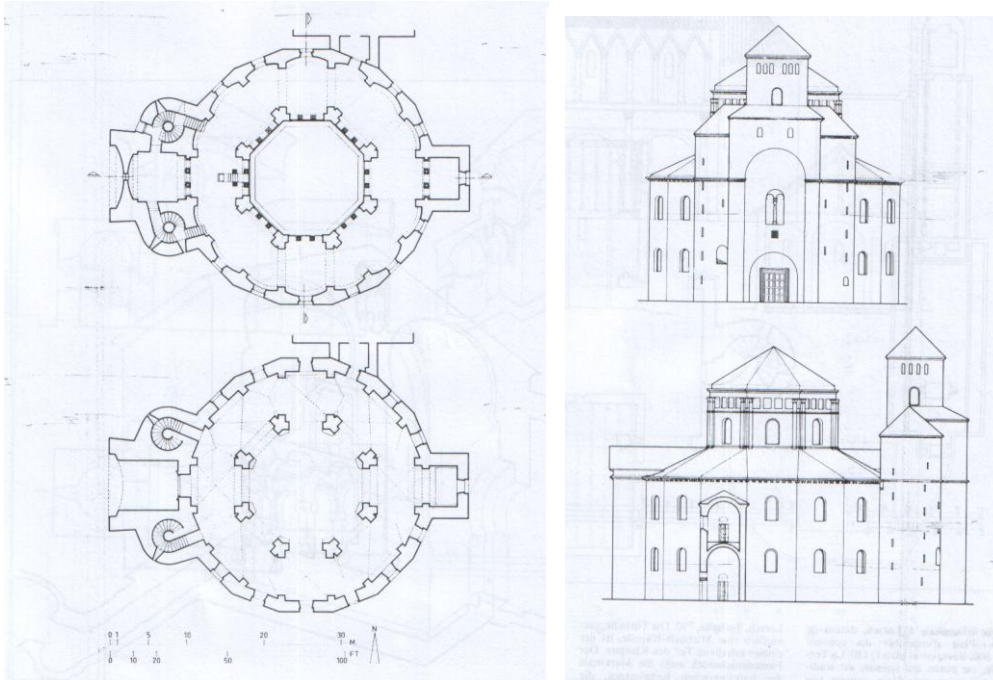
Chapelle Palatine d'Aix : plans et élévations
